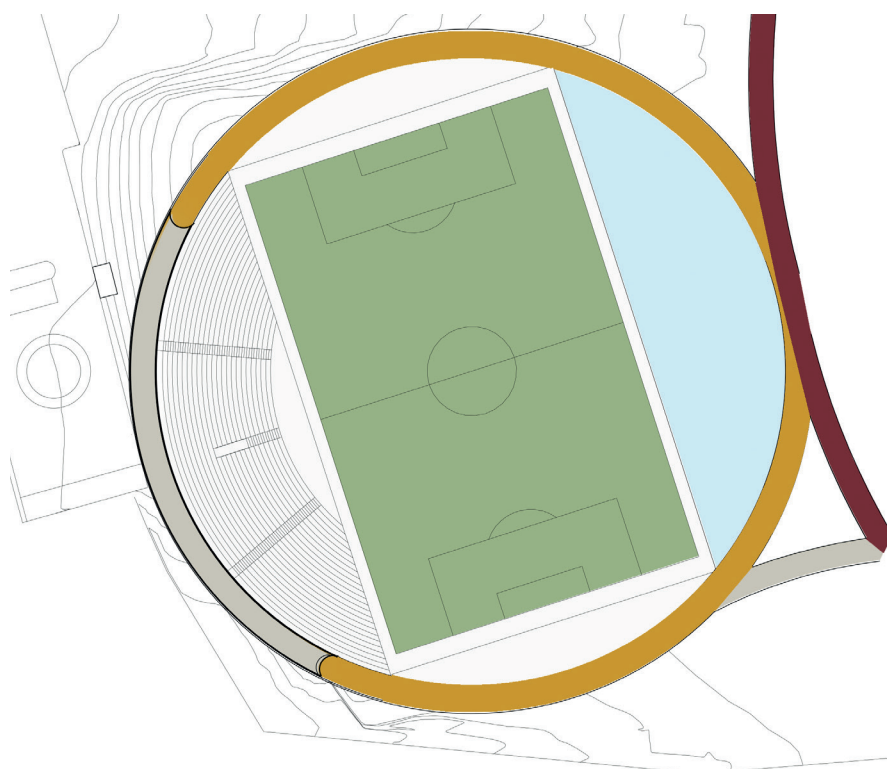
Planta da Cobertura do estádio. Realizado em CAD pela autora.
